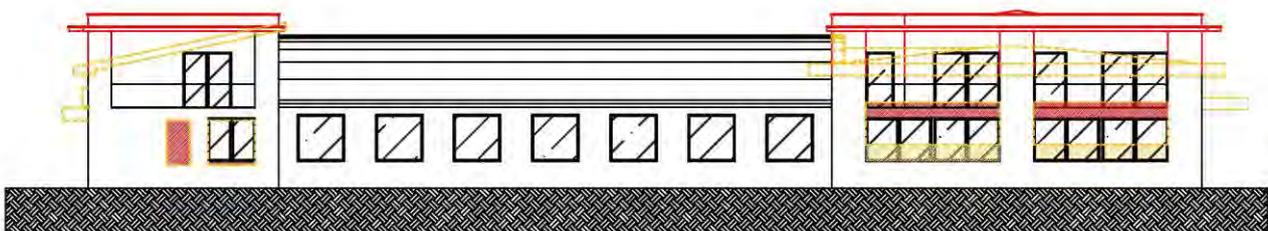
Tipologia di progetto prospetto est tato sovrapposto.
